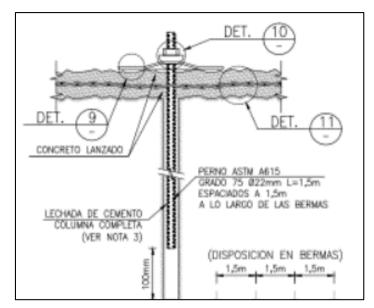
Detalle de cáncamo en Berma Fuente: Plano MQ11-03-DR-4110-CE6008
